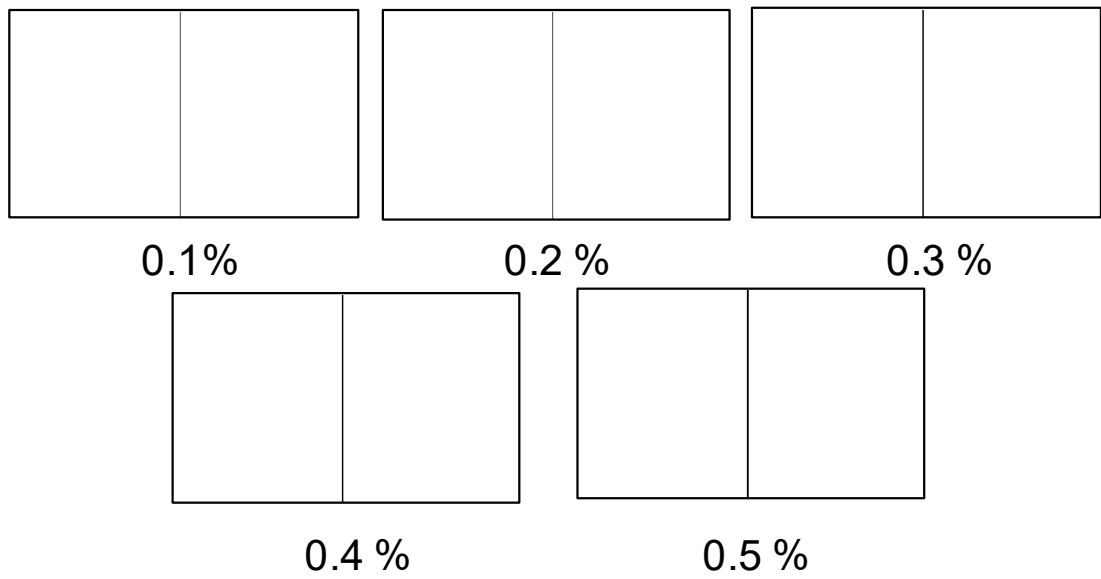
ひび割れ開口面積率別ひび割れモデル図
